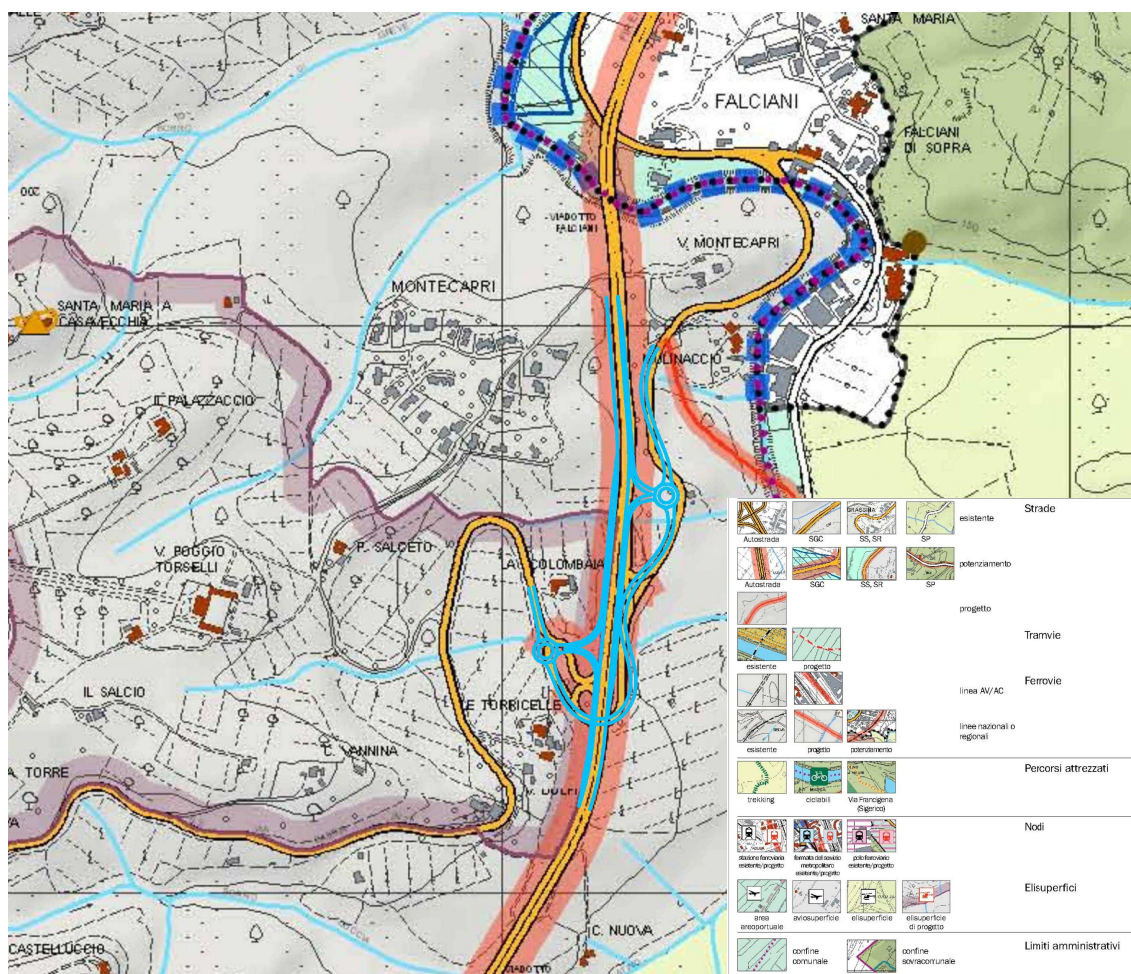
Stralcio della Tavola della Rete Stradale del PTCP, con la sovrapposizione del nuovo svincolo in progetto
